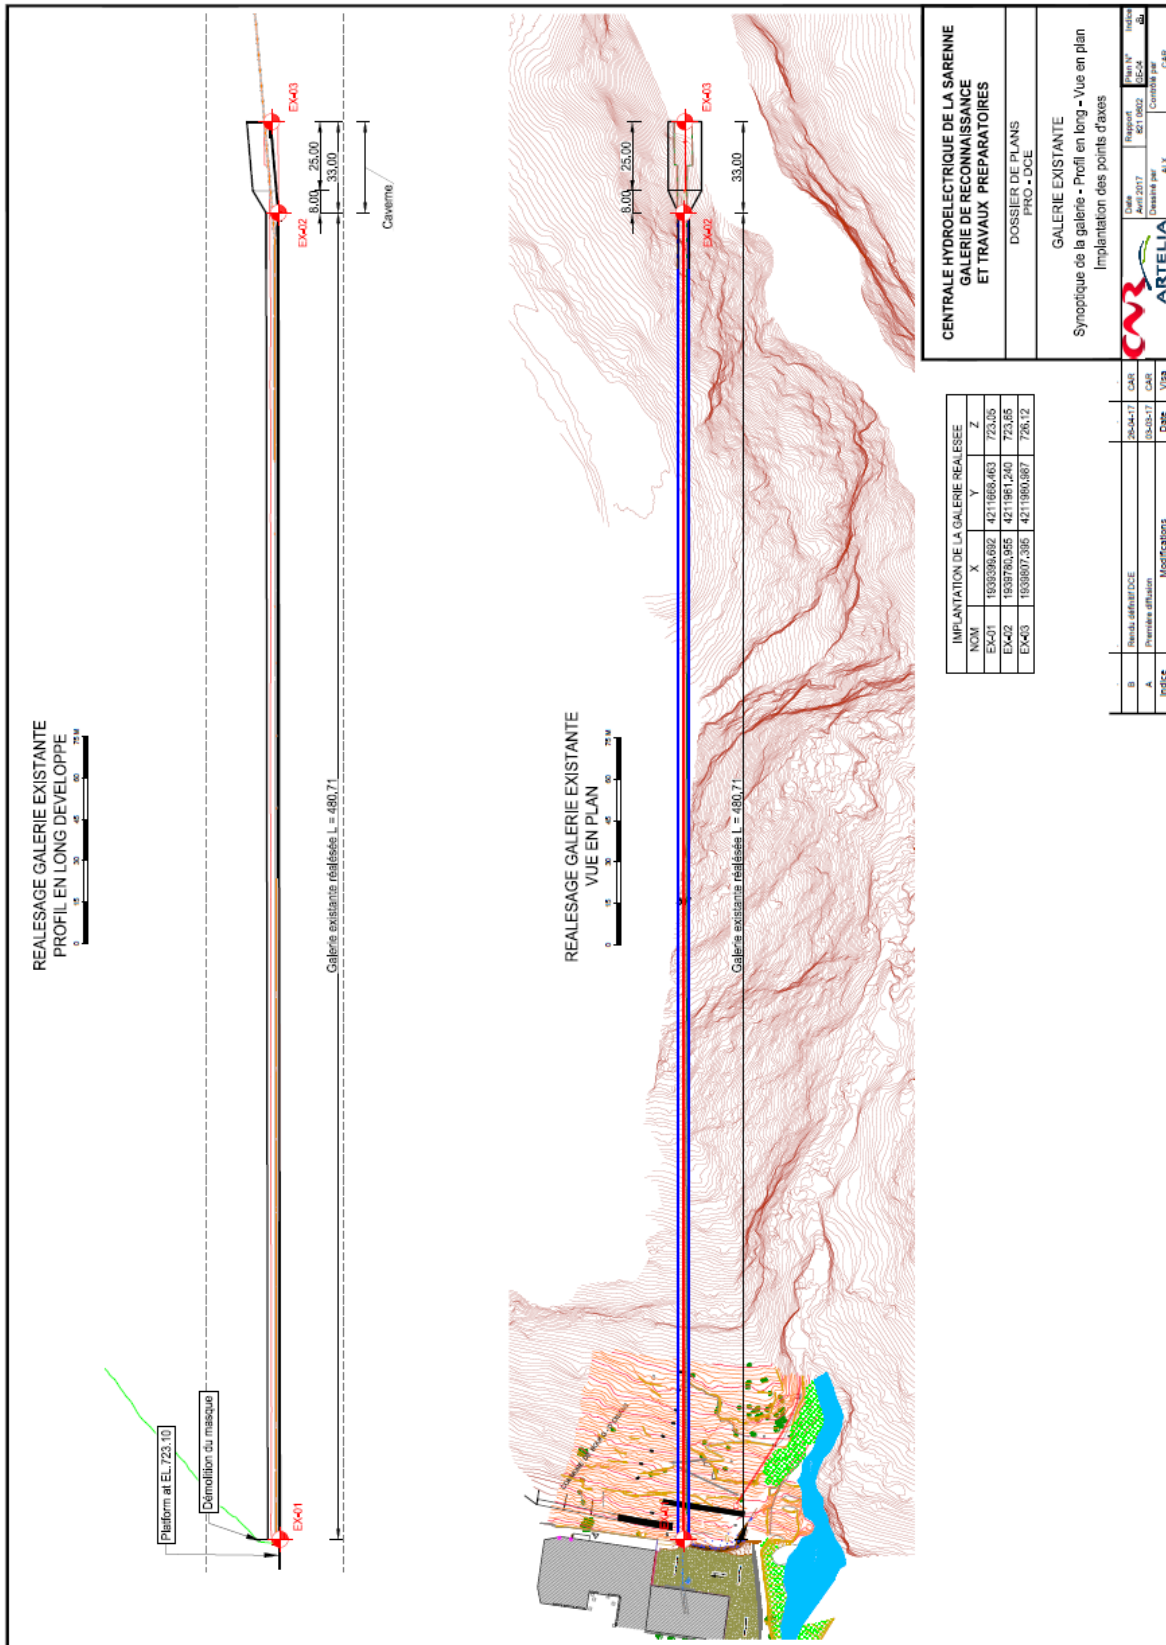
Vue en plan et profil en long du réalésage de la galerie existante
